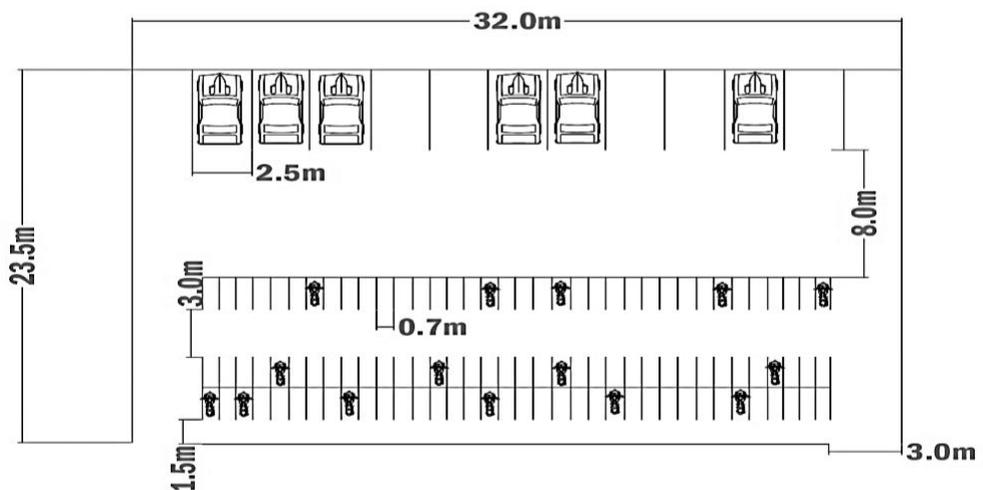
Layout Rencana Lokasi Parkir Off Street Pada Kawasan
